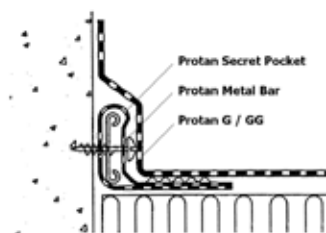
Fixation au droit de l'angle du relevé avec Secret Fix Pocket
